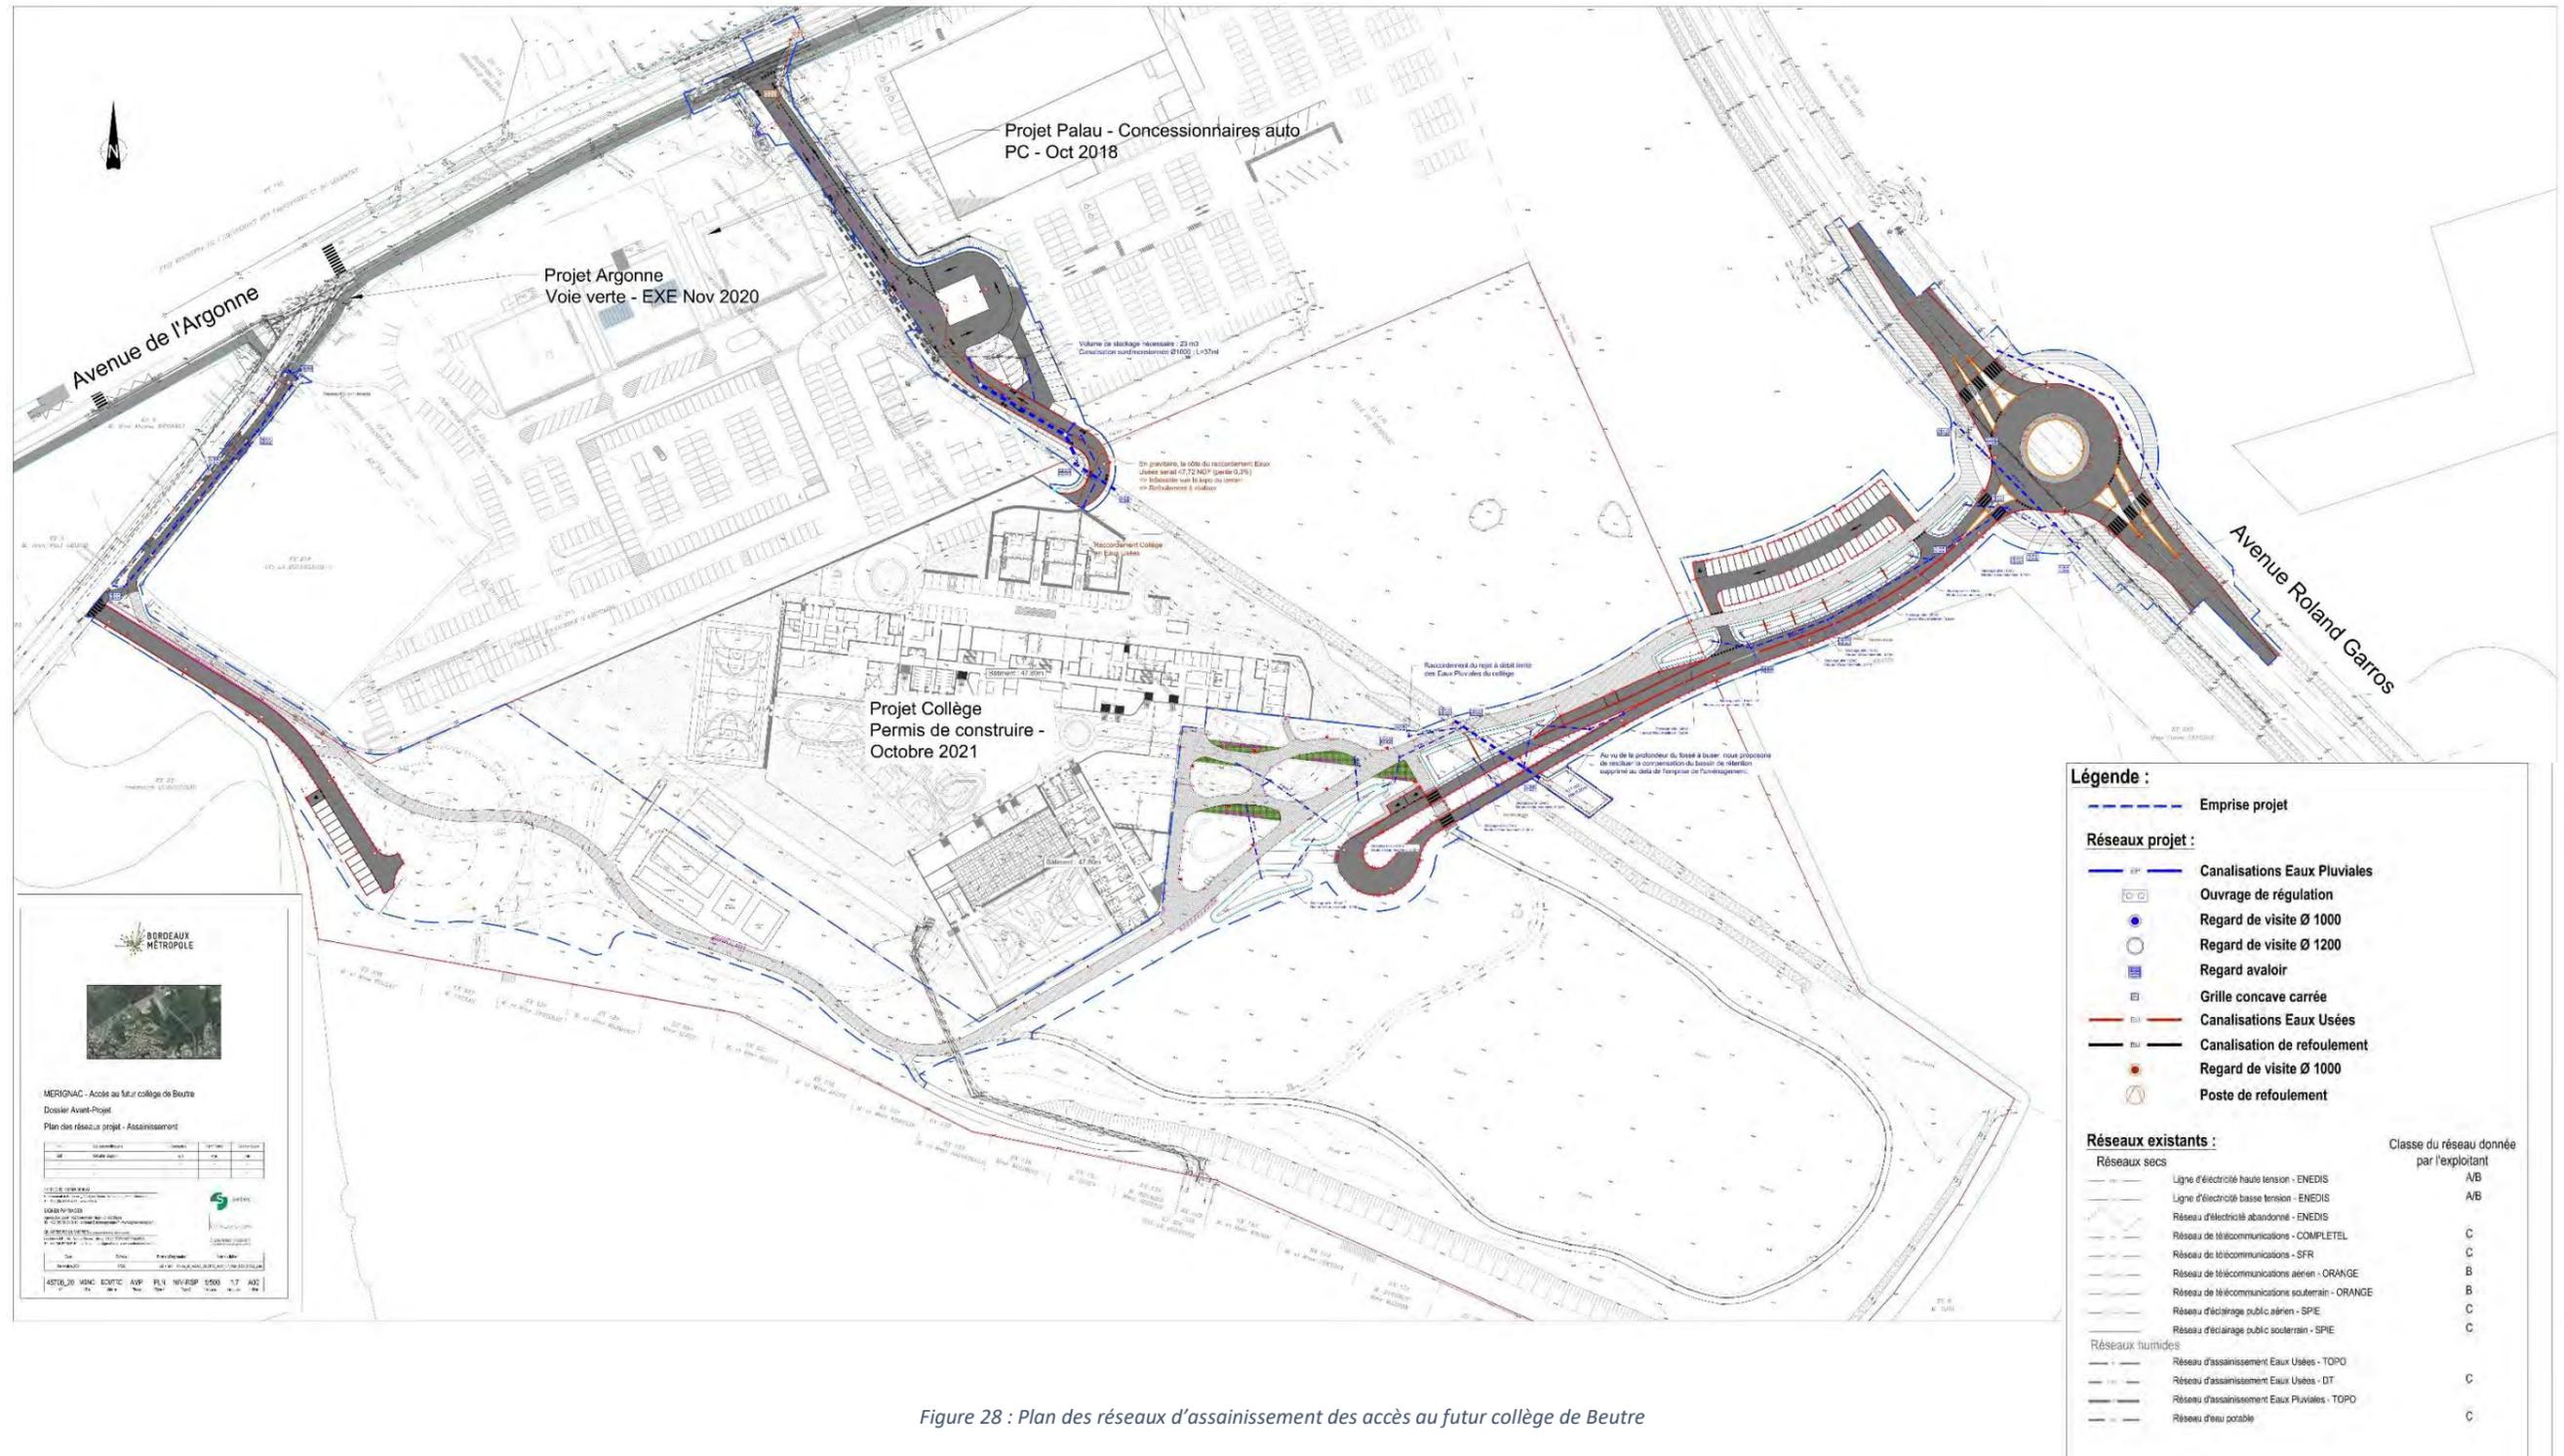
Plan des réseaux d'assainissement des accès au futur collège de Beutre
